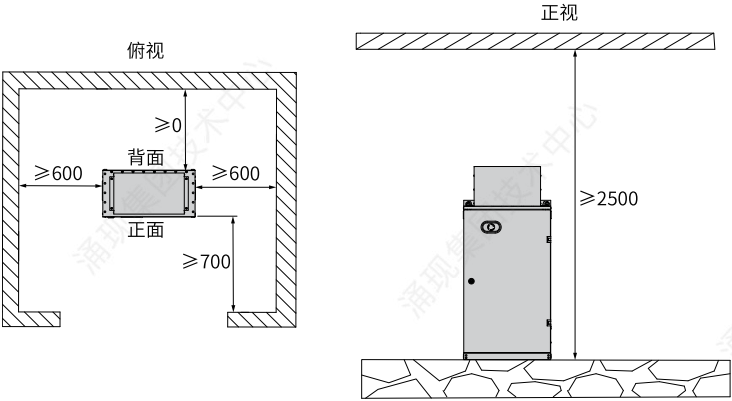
有机房控制柜安装空间要求示意图（单位：mm）
